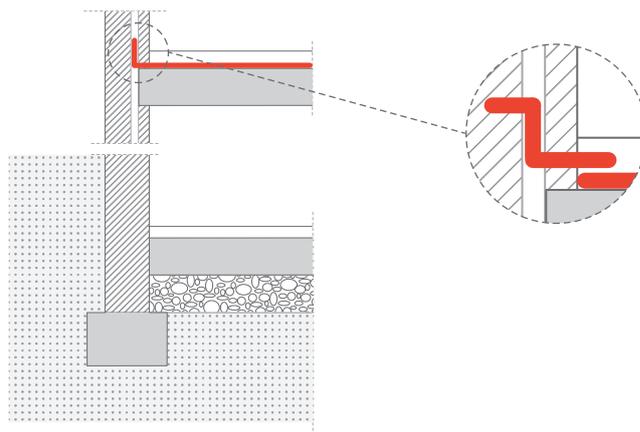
Encuentro de la barrera tipo lámina con una fachada cuando se vaya a ejecutar una nueva hoja interior
